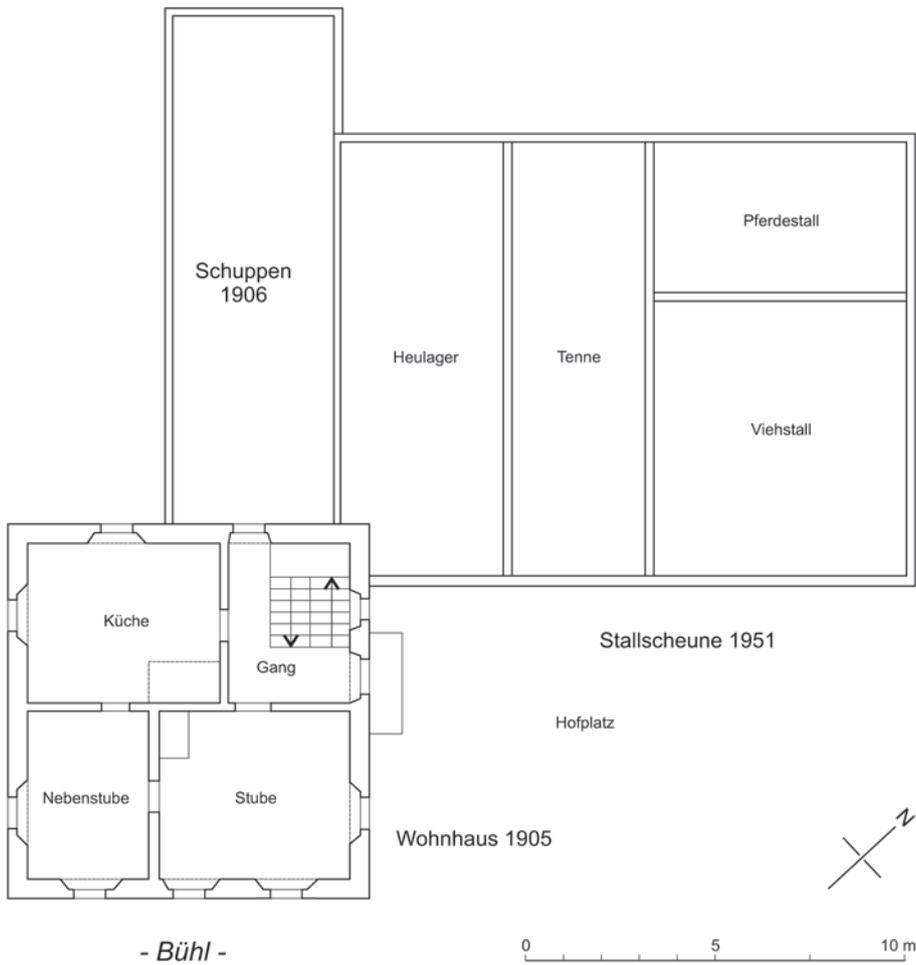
Grundriss Erdgeschoss. M. 1:200.
